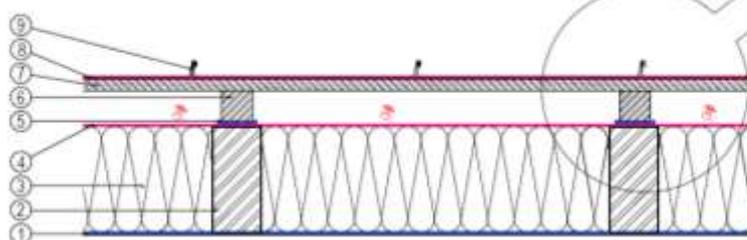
Конструкция крыши с металлической кровлей и диффузионной плёнкой, уложенной на утеплитель. Фальцевая кровля смонтирована на сплошной настил с разделительным слоем.
